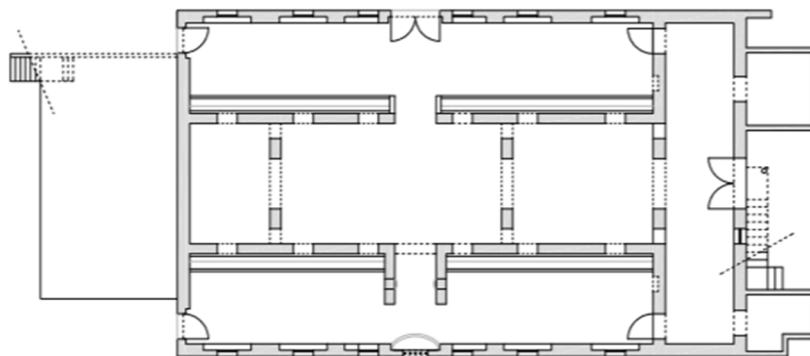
Levantamento da definição geométrica, Planta do piso térreo
